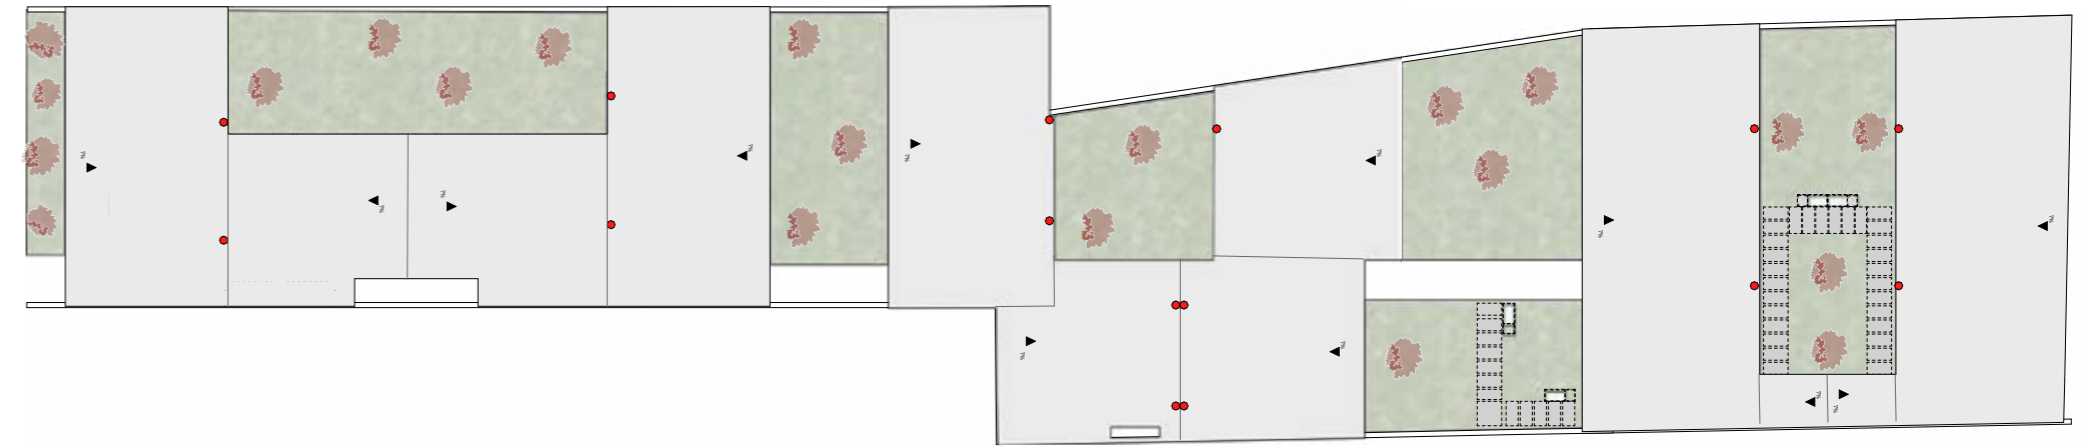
Diagrama de bajantes de agua en planta de cubiertas del proyecto. Nota. Elaboración propia
